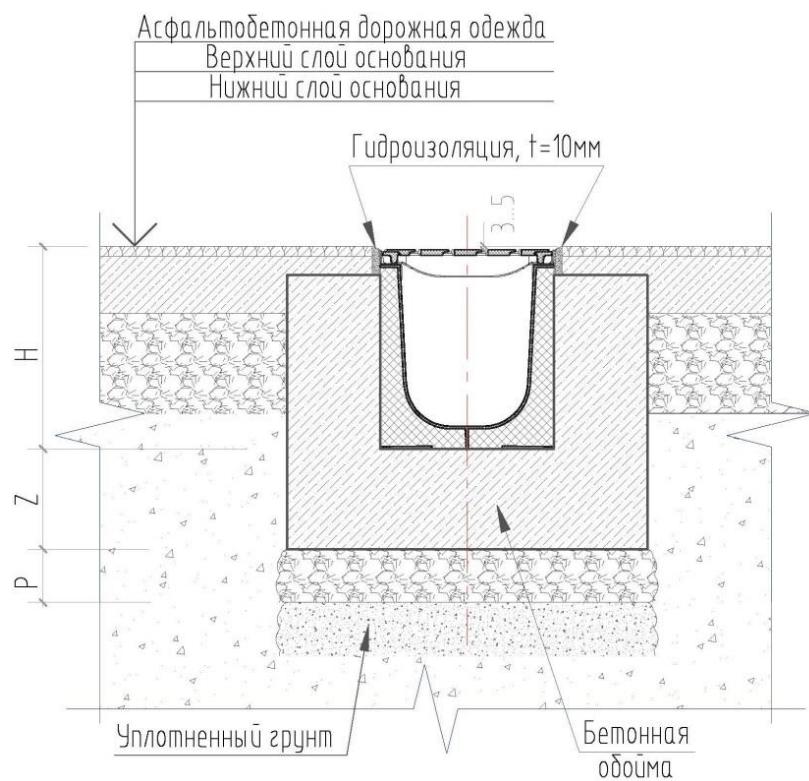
б – Монтаж пластиковых лотков с асфальтобетонным покрытием.
